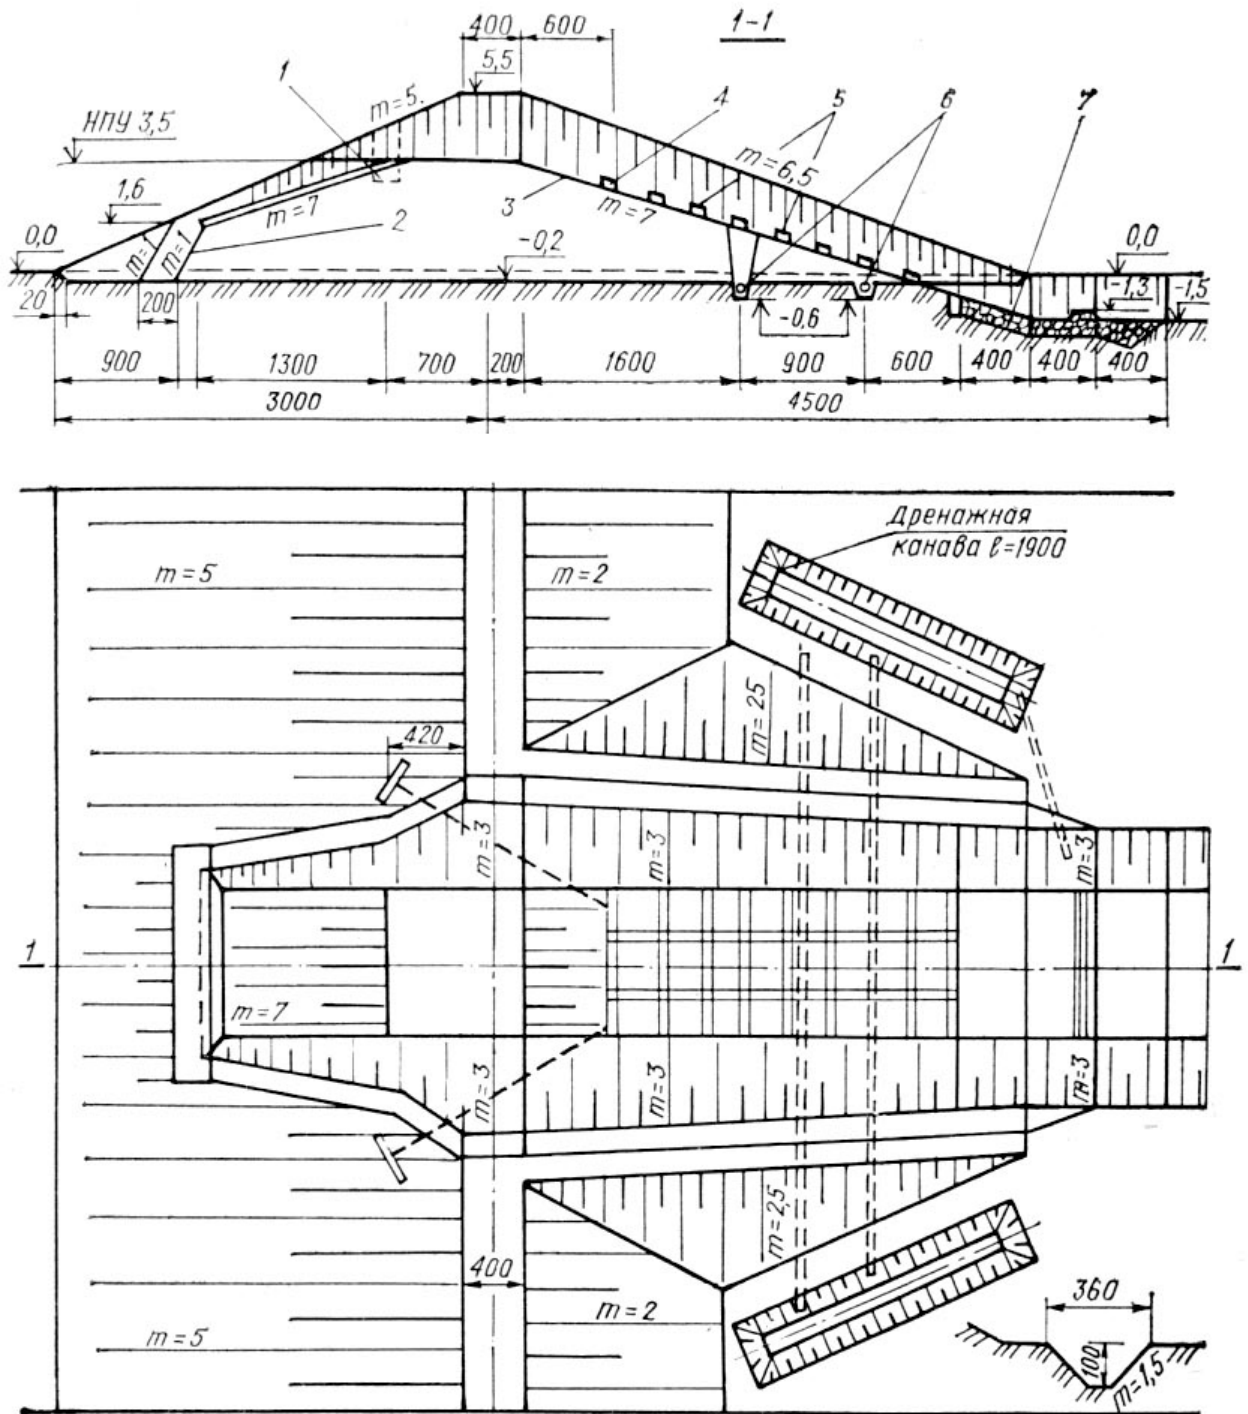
Грунтовая водосливная плотина с асфальтобетонным покрытием
